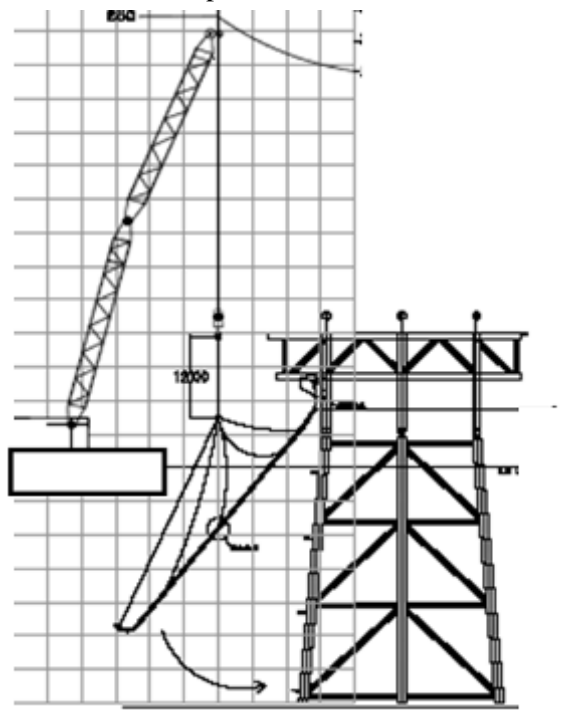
o: Schema Installazione Riser –J-Tube Tipo
